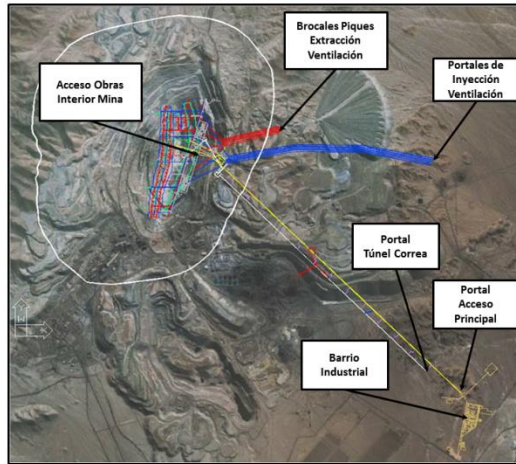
Vista en planta de Obras de Infraestructura Permanente
